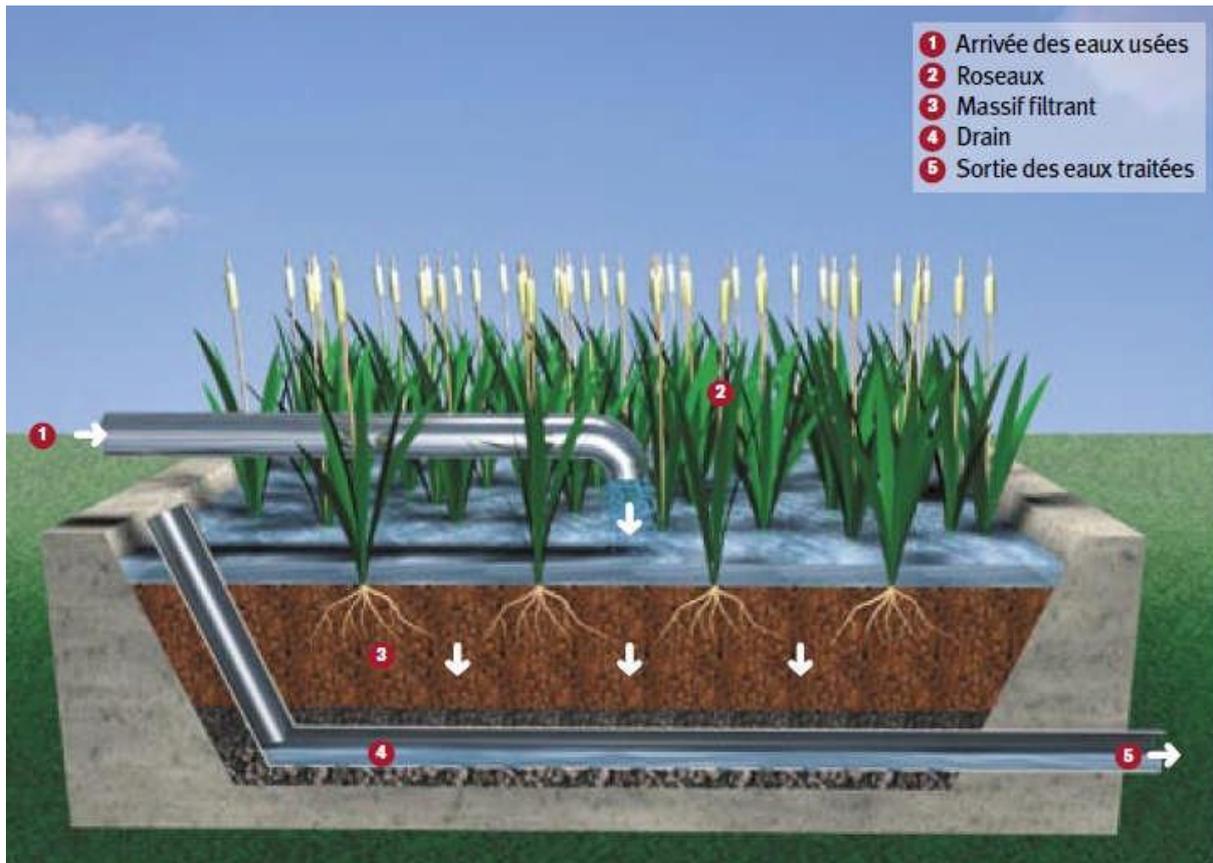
Coupe d'un lit filtrant vertical planté de roseaux.
